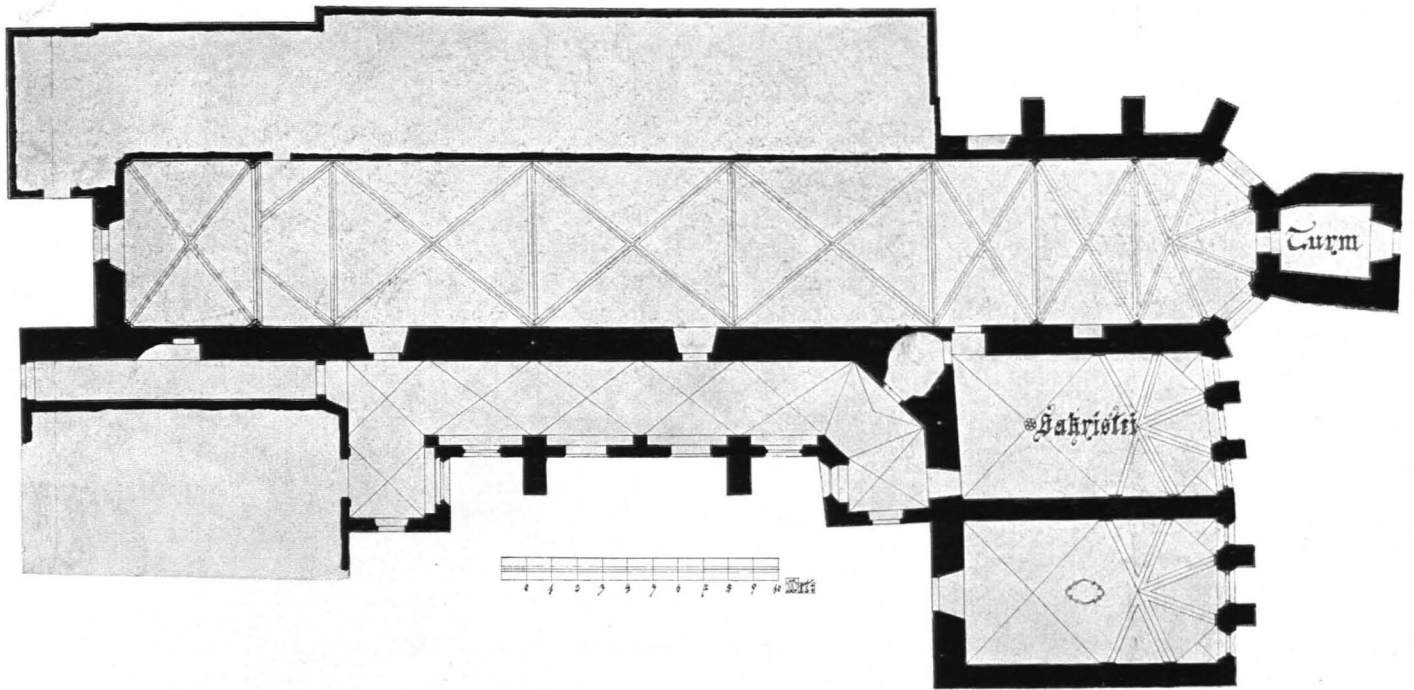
Aggsbach, Pfarrkirche, Grundriß (S. 3)
